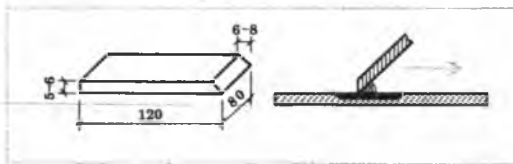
Резиновый шпатель и процесс нанесения шпатлевки с его помощью
